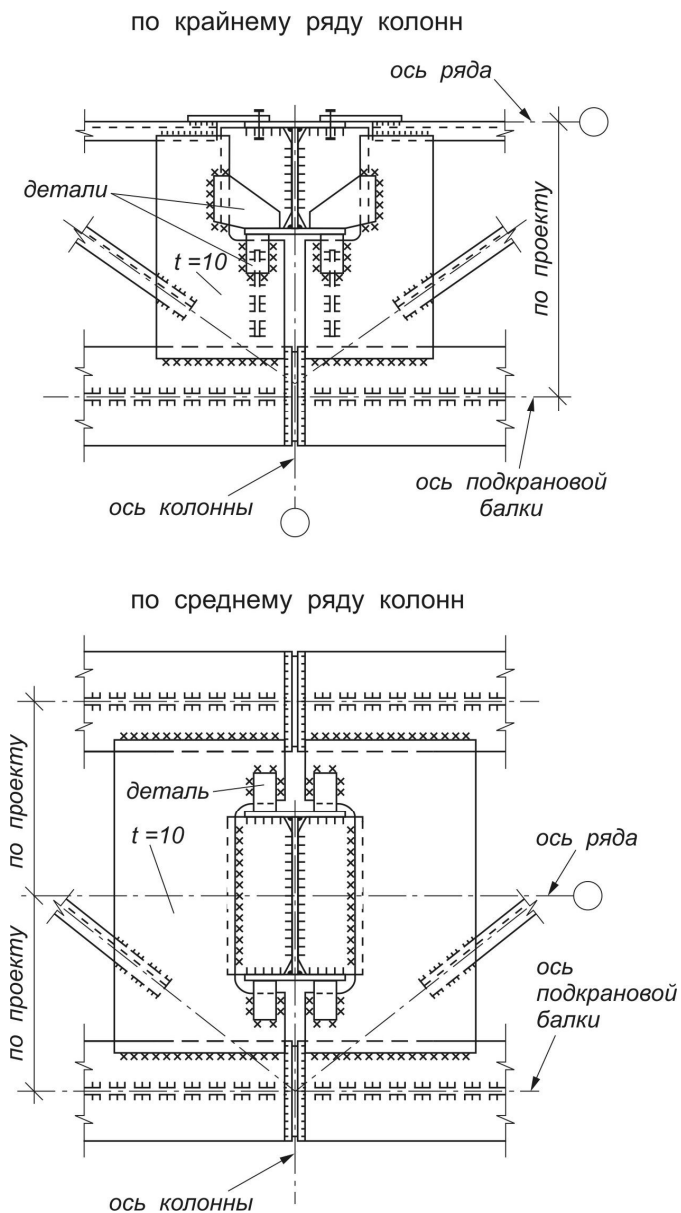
Сопряжение разрезных подкрановых конструкций в уровне верхнего пояса при тормозных фермах
